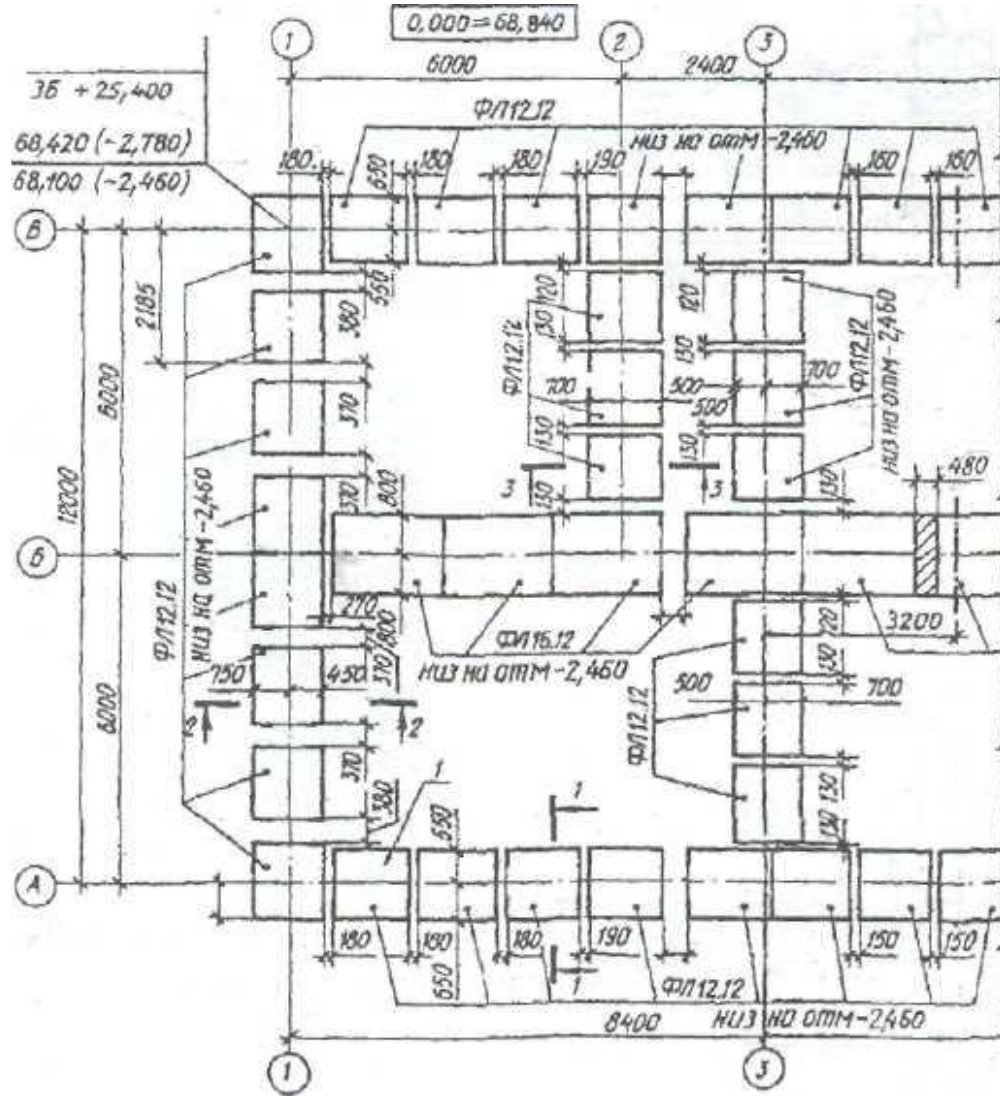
Фрагмент оформления плана ленточных фундаментов под стены
